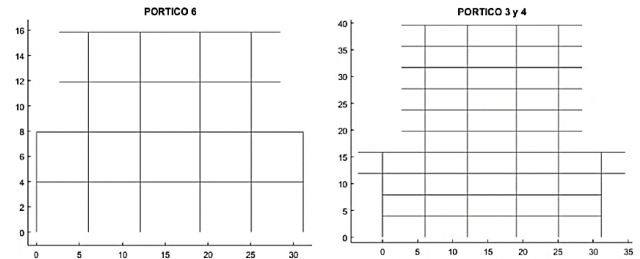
Pórticos del Banco de Manta modelados en CEINCI LAB.
